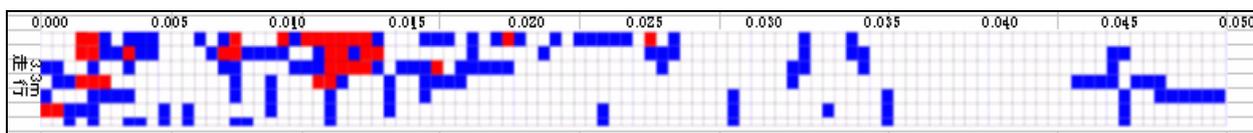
ひび割れ状況図 ③ひび割れ診断マーク
